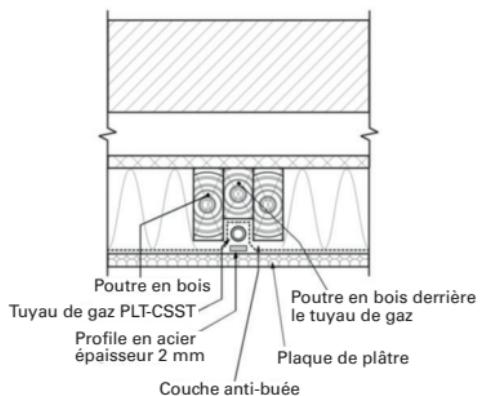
Configuration spatiale 4 : Exemple d'un tuyau de gaz sur une poutre en bois derrière un mur en placoplâtre.
